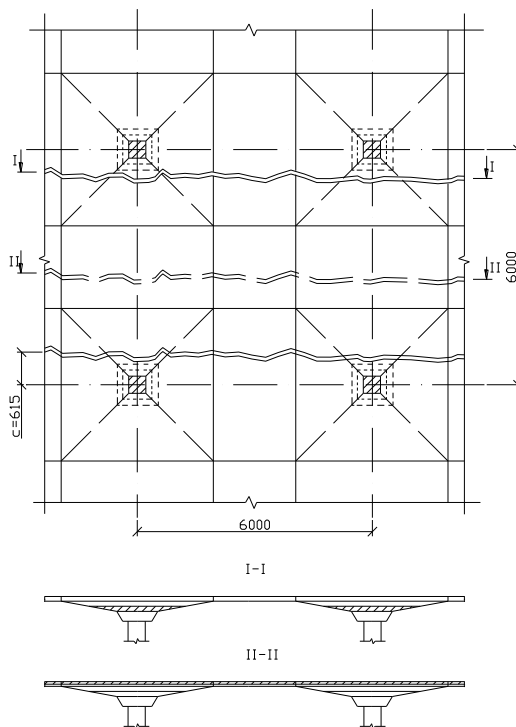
Схема полосового излома перекрытия (штриховкой обозначены сечения с сжатой зоной бетона).
